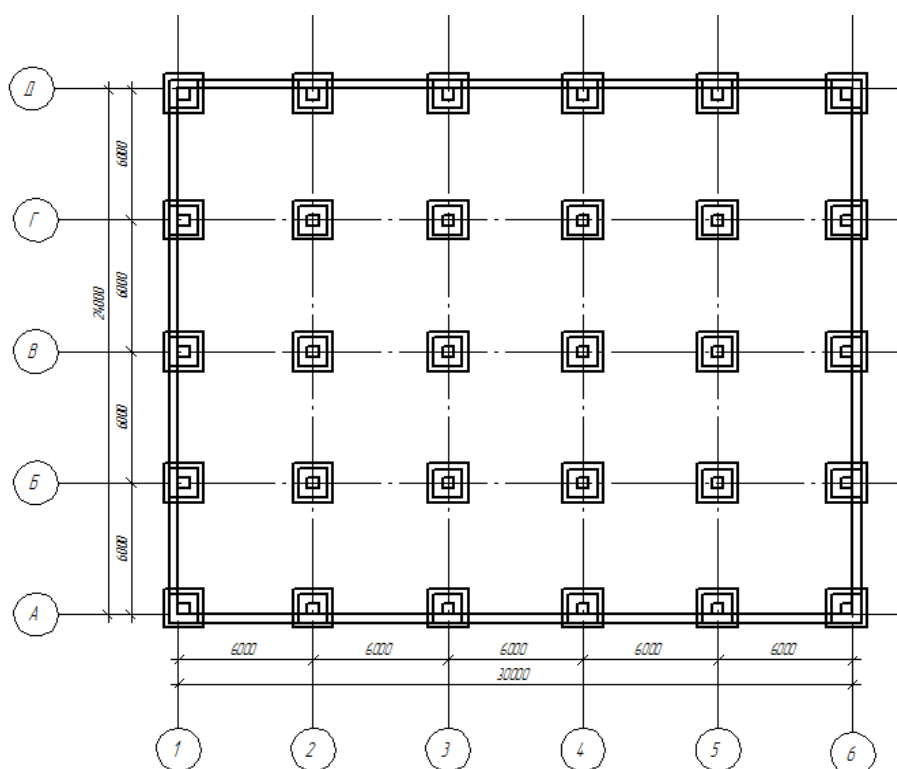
Схема расположения столбчатого фундамента и фундаментных балок
